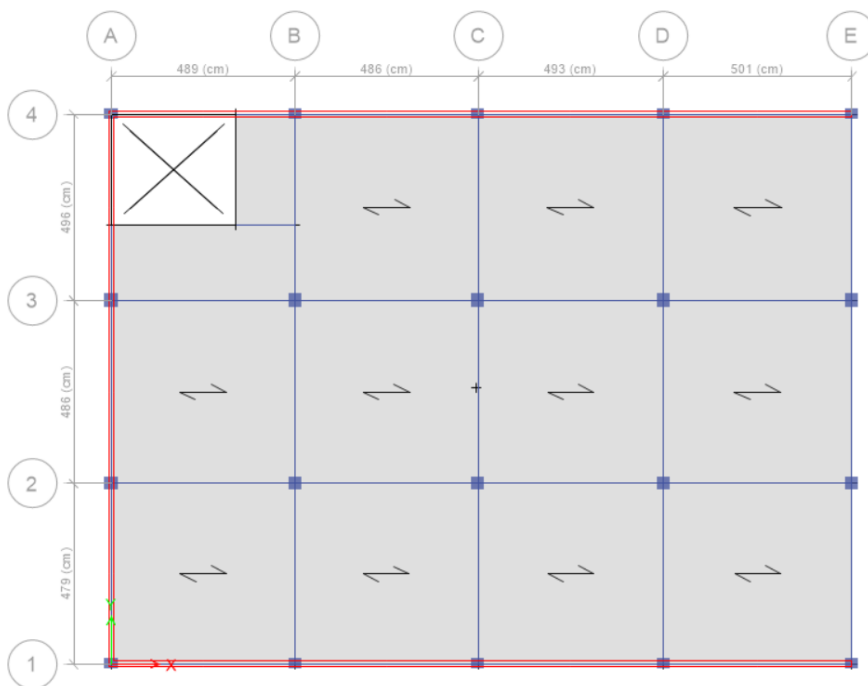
Distribución de elementos estructurales - Nivel 02 y 03
